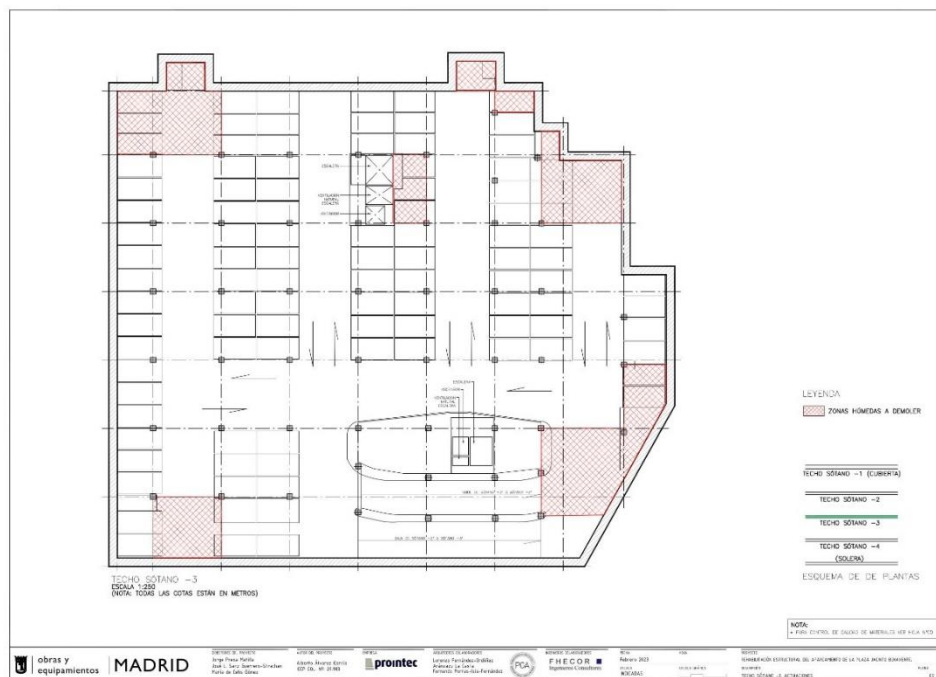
Plano Planta Sótano -2 que muestra las zonas confirmadas como húmedas, sombreadas en rojo
